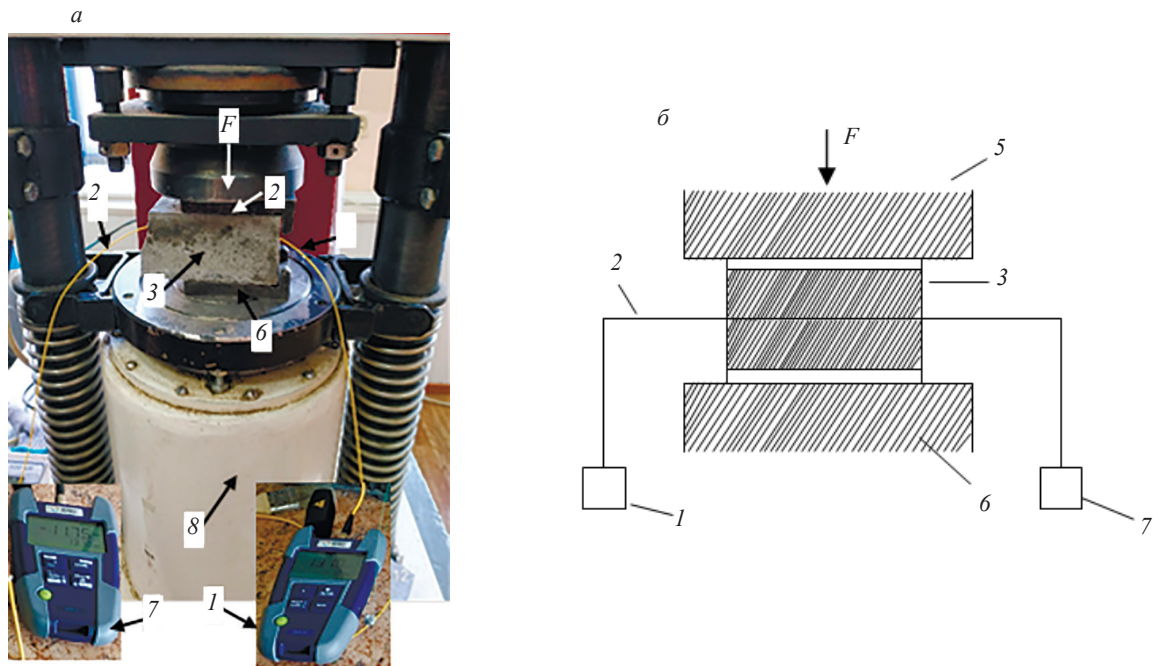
Пресс гидравлический измерительный ПГИ-500:
